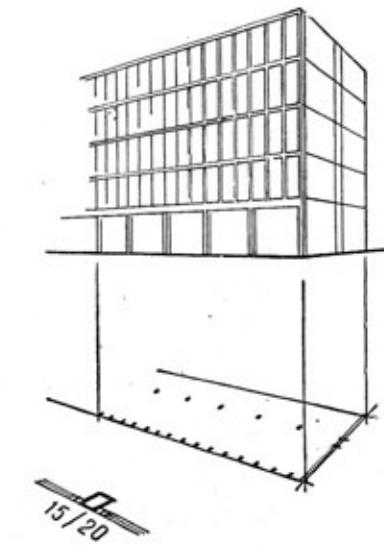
Железобетонные перекрытия при узком шаге колонн
